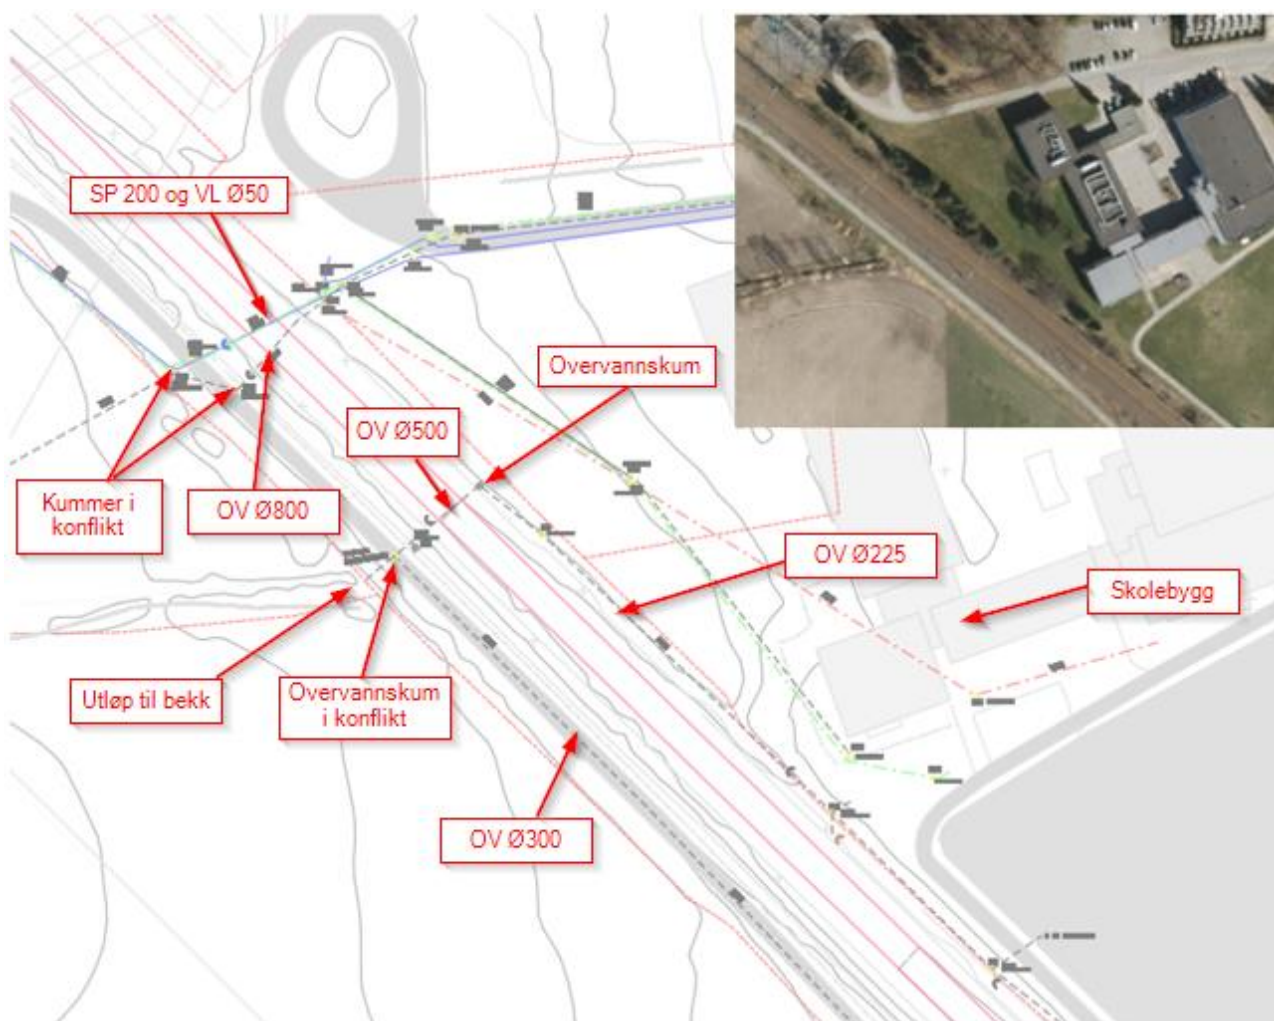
Eksisterende VA plankart og ortofoto km 68,520-68,760
